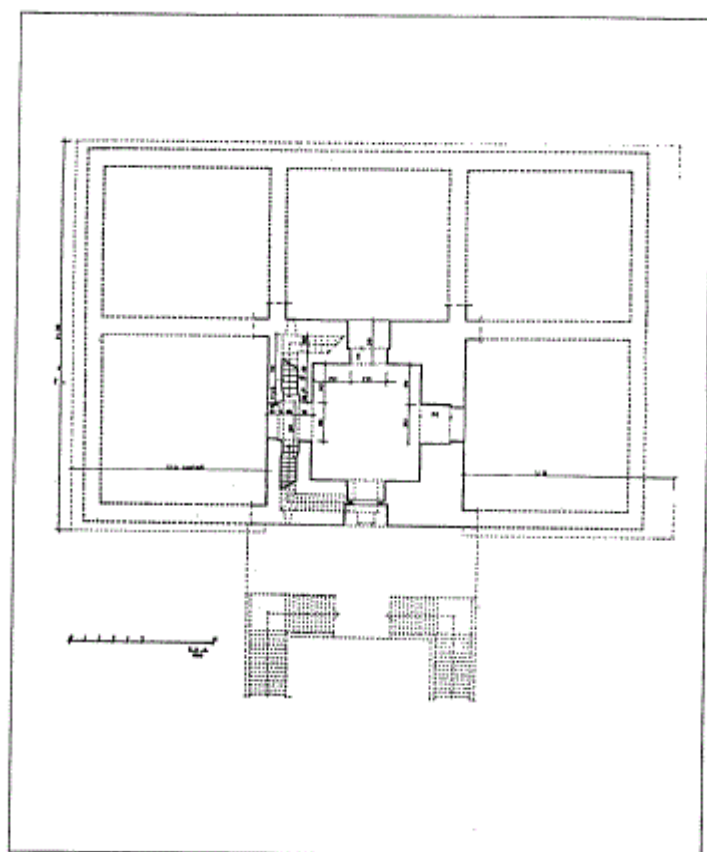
مسقط أفقي لخان مورياكا في سرايفو (عن: Cezar).
